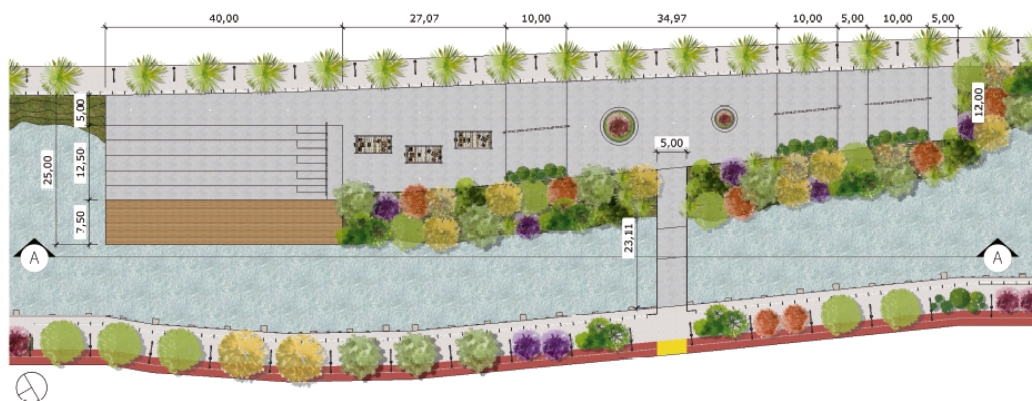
Planta Layout 03. Fonte: Autoral, 2022.
